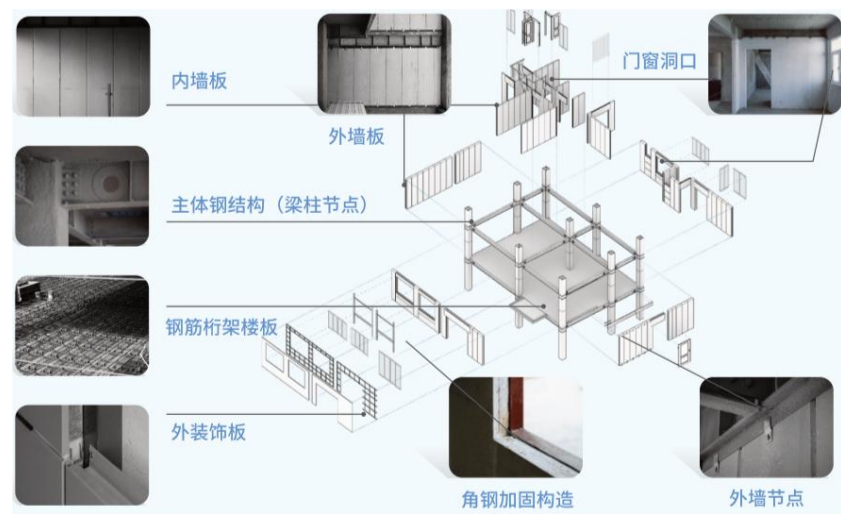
GS-Building 钢结构装配式建筑体系示意
